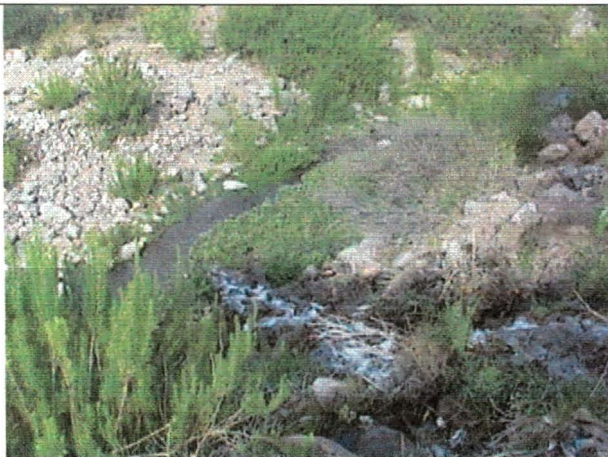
Tramo Final sin Revestimiento Canal La Polcura
